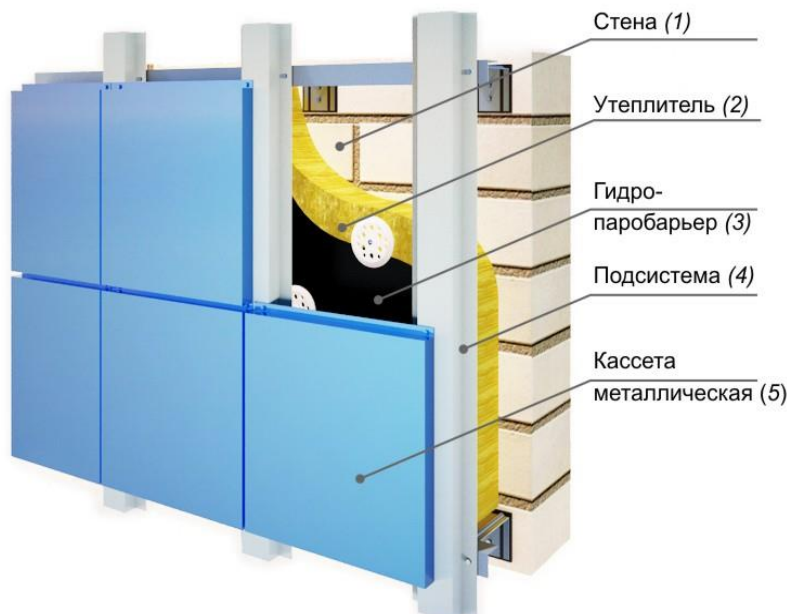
Навесной вентилируемый фасад облицовкой металлическими кассетами
